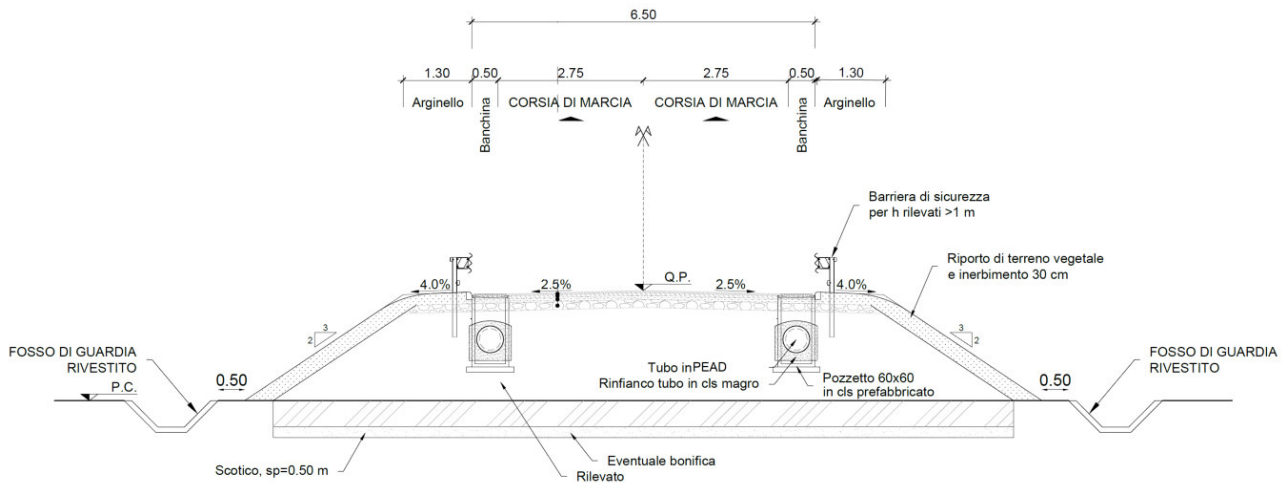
Esempio sezione tipo in rilevato con sistema chiuso
